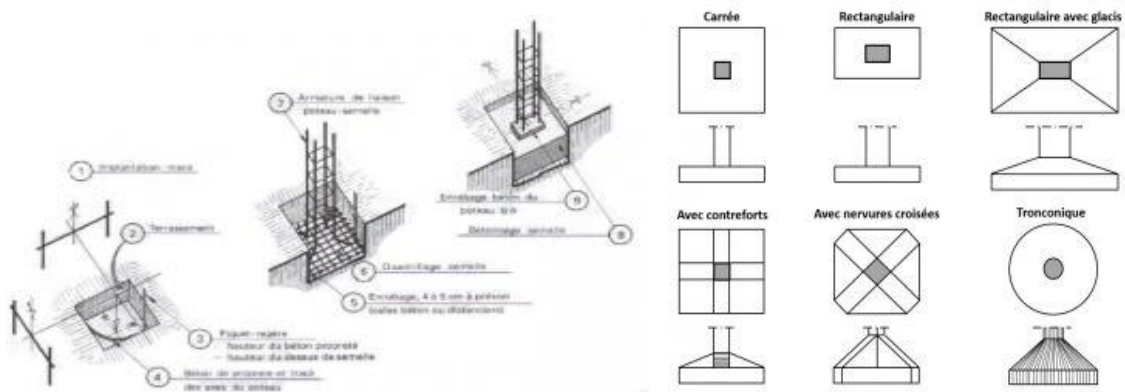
exemple de semelles isolées (la source : <https://www.toutsurlebeton.fr/mise-en-oeuvre/la-semelle-isolee-fondation-superficielle-pour-poteau/>)
